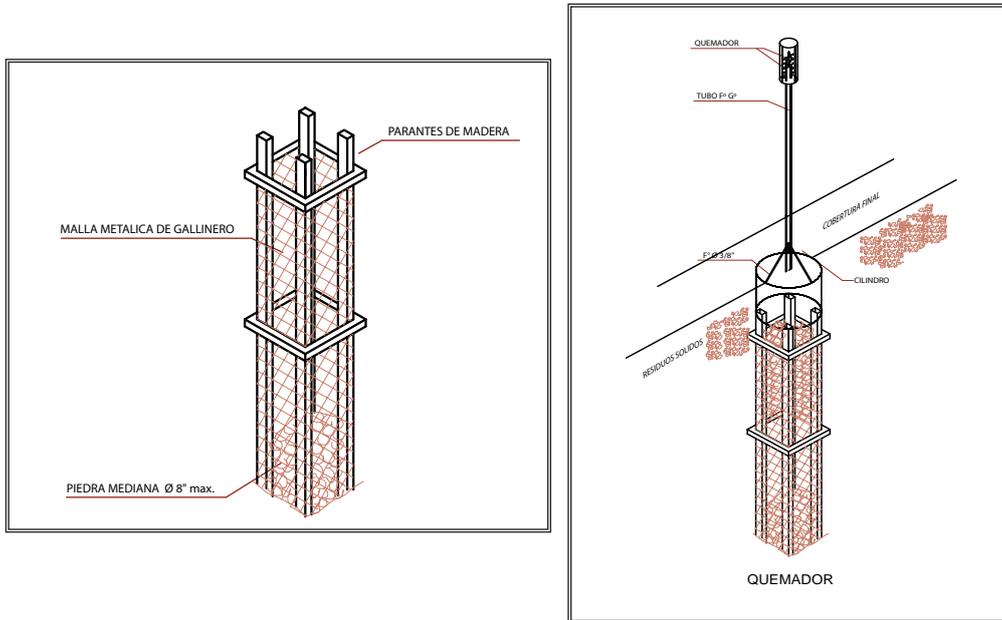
Construcción de chimenea – Instalación de quemador.
